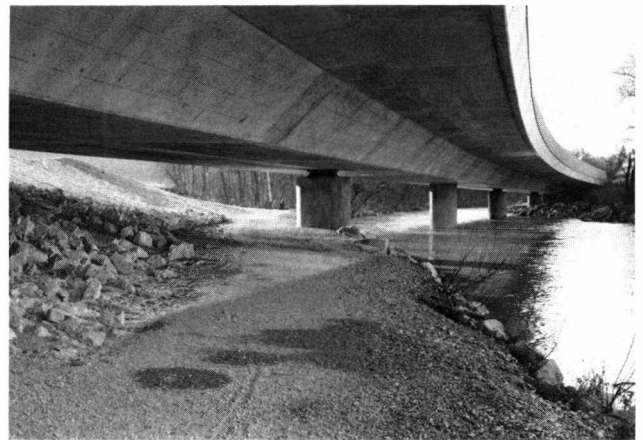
Birs mit Brückenuntersicht – La Birse avec pont vu d'en bas – The river Birs with underside of bridge
